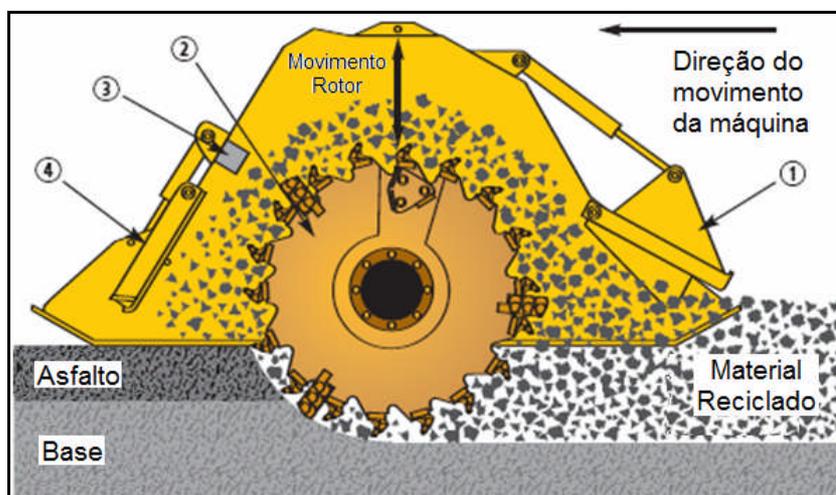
Detalhe técnico do tambor de corte da Recicladora CAT -RM 350B.
